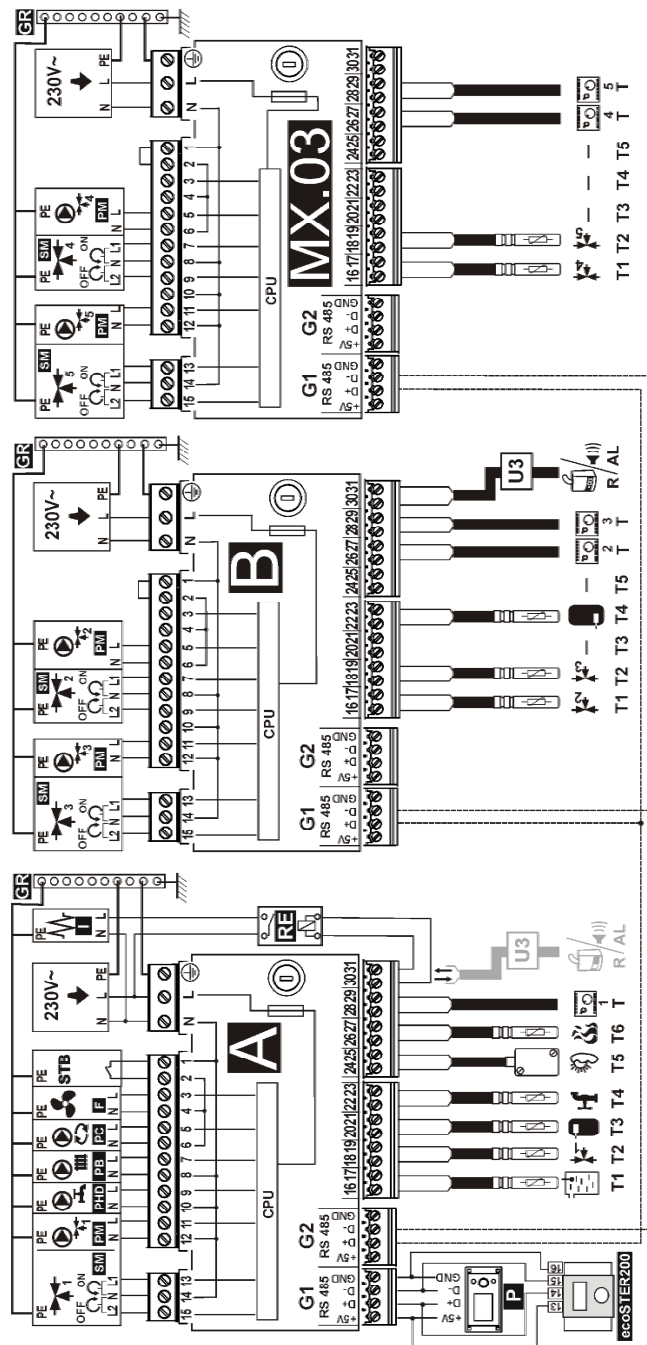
Beschreibung der Verbindungen der Steuerung ecoMAX800D Holz Master für Kessel
